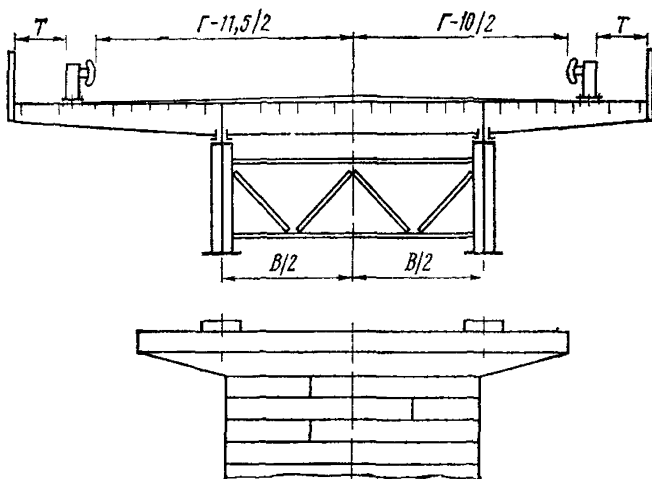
Уширение сталежелезобетонного пролетного строения за счет замены железобетонной плиты гальвной ортотропной
